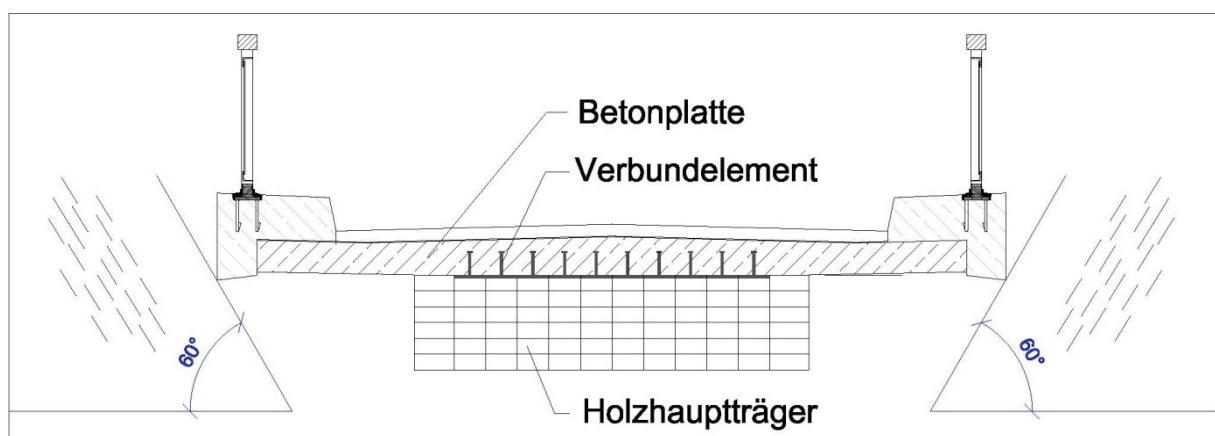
Betonplatte als konstruktiver Holzschutz in einem Holz-Beton-Verbundüberbau
